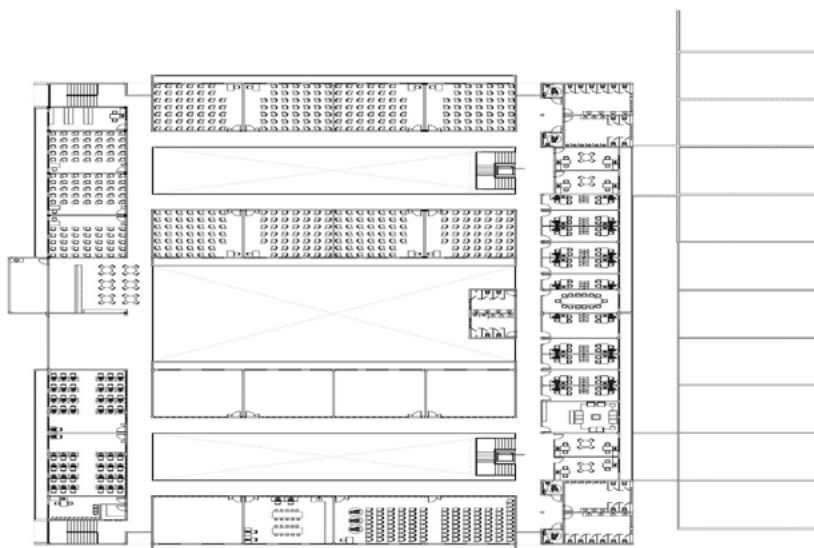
Planta baixa do pavimento superior da Unidade Didática II
